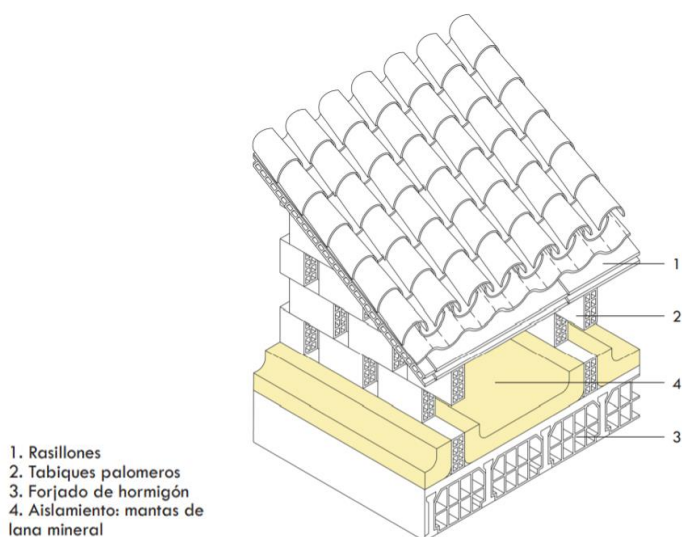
Detalle dunha cuberta cun illamento colocado sobre o forxado horizontal<sup>59</sup>
